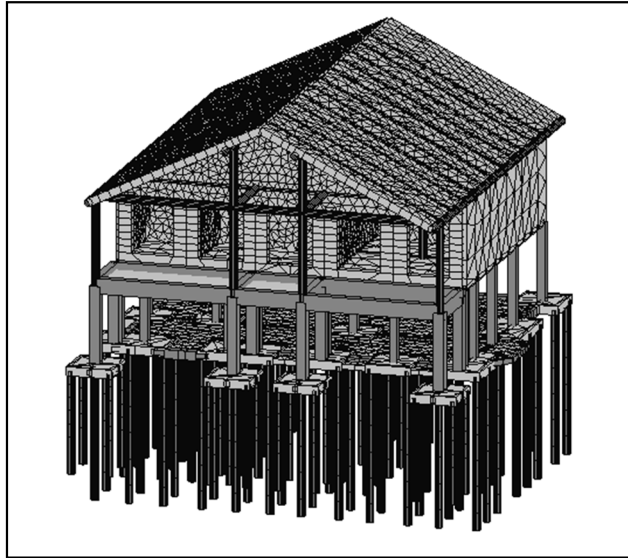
3-мерная компьютерная модель жилого дома с учётом усиления фундаментов
